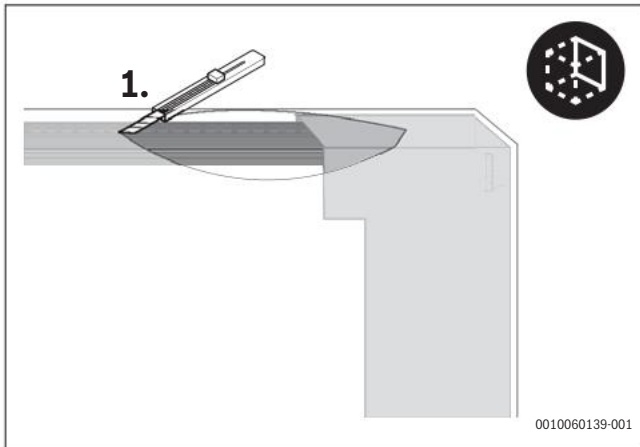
Découpe de la feuille à l'arrière du radiateur
